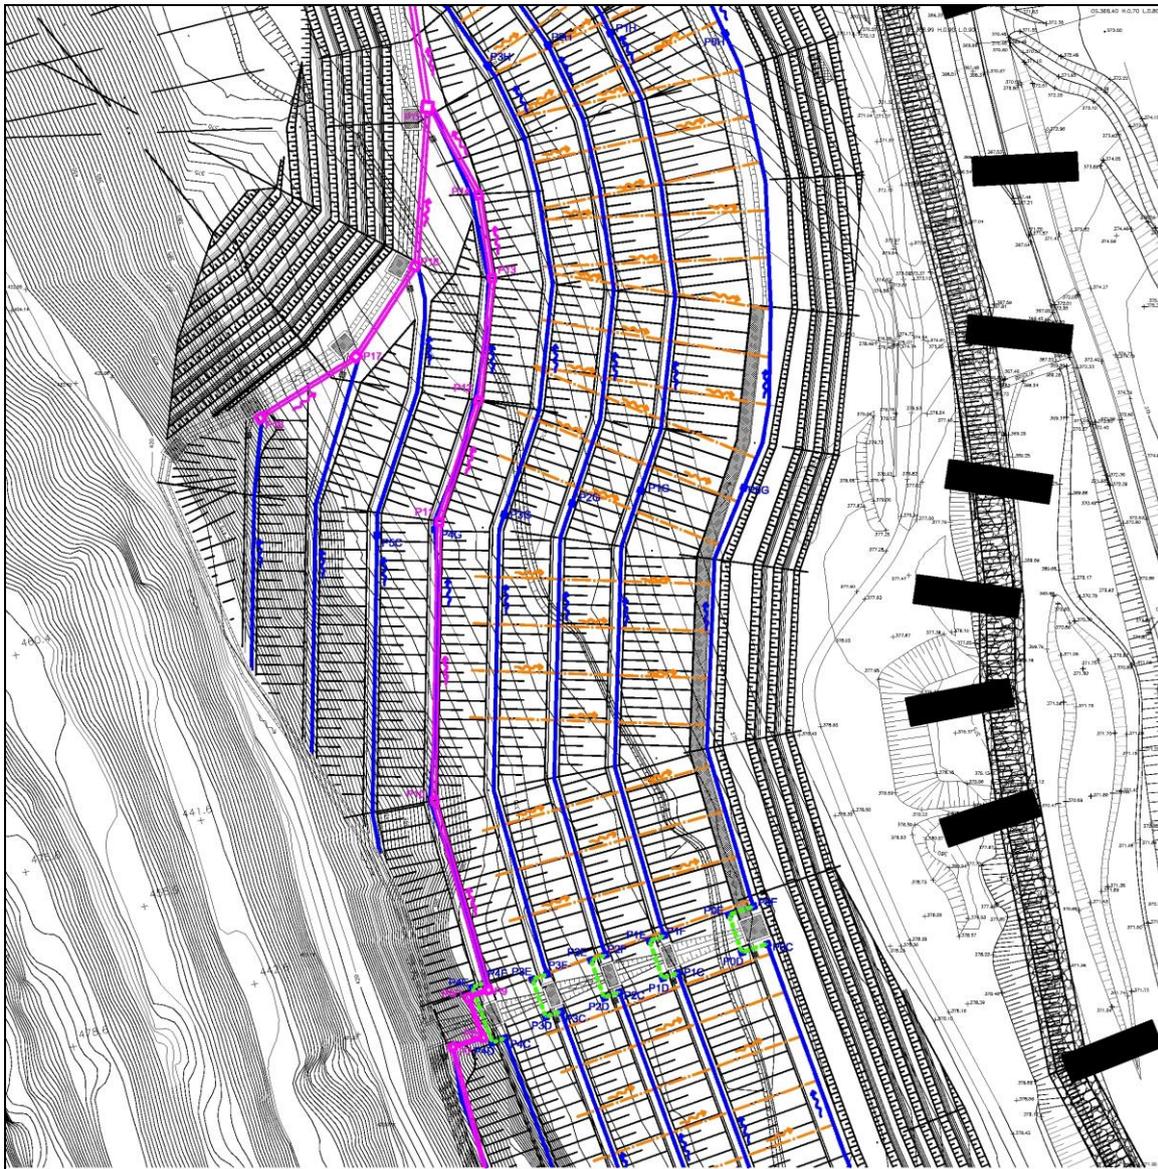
Linea di drenaggio principale sud – secondo tratto
